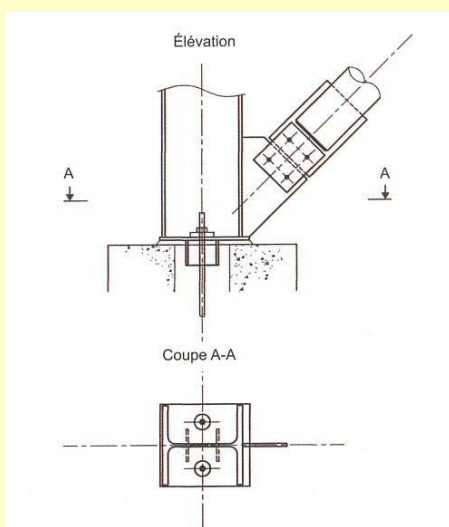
Pied de poteau articulé de palée de stabilité.
